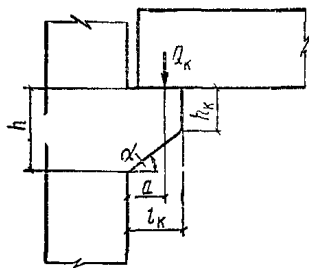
Расчетная схема для короткой консоли при расчете ее по прочности на действие поперечной силы
